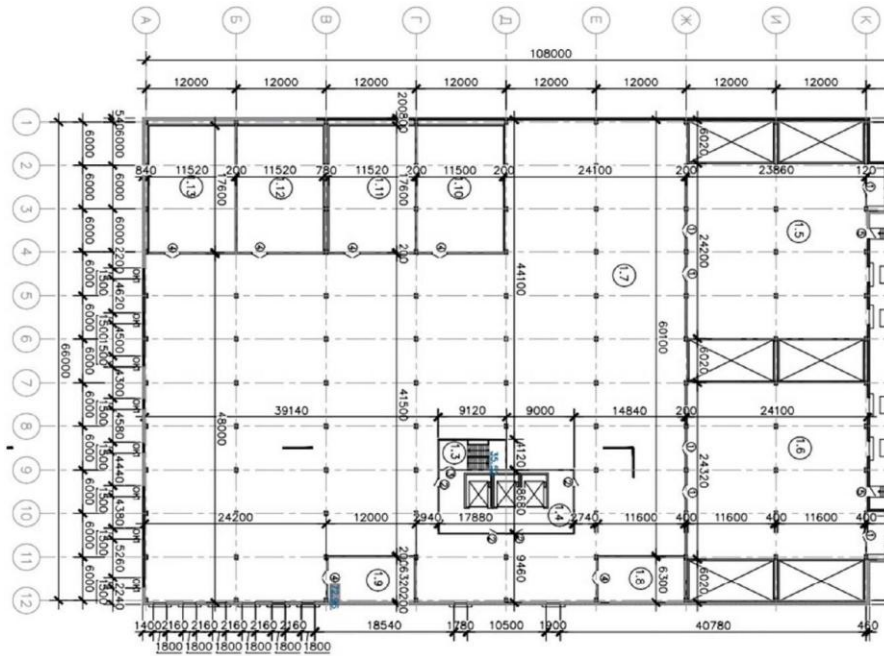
Розглянута плита перекриття на відмітці
